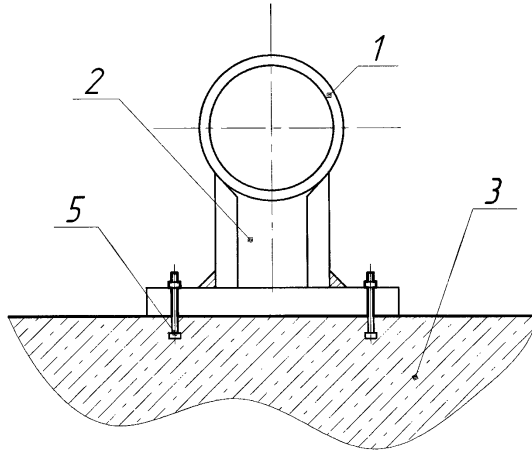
Пример назначения границ между опорными конструкциями и строительными конструкциями
